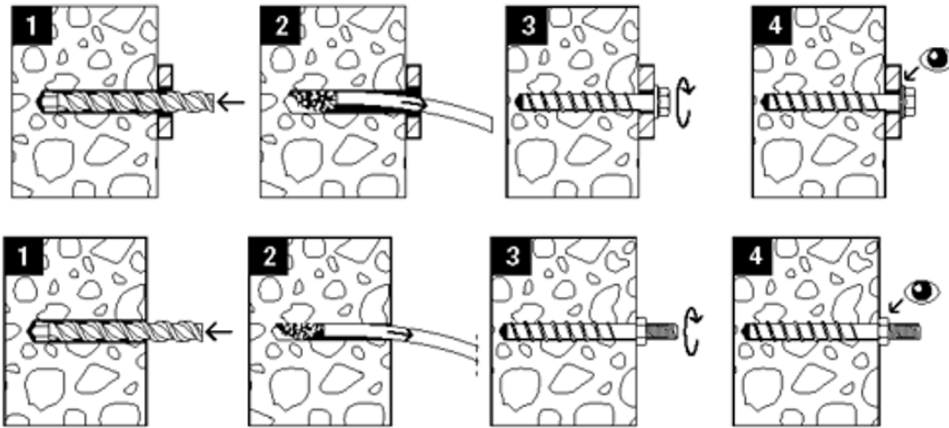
Einbau der Betonschraube gemäß der Einbauanleitung des Herstellers (oben: Durchsteckmontage, unten: Vorsteckmontage).
